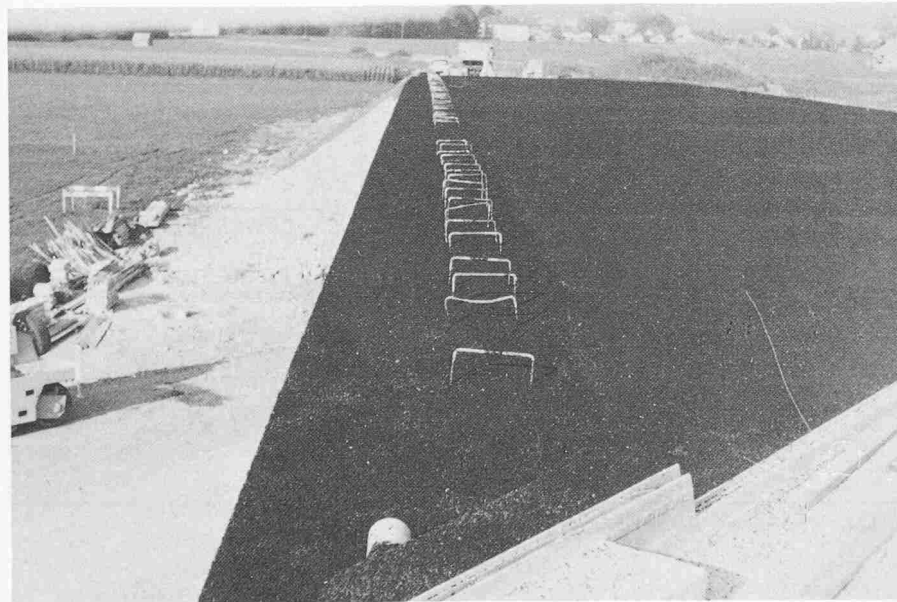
Efkaprene-Brückenabdichtung bis zum Brückenrand gezogen. Anschlussbewehrung für Gehwegaufbau einbetoniert. Beispiel an der N12
